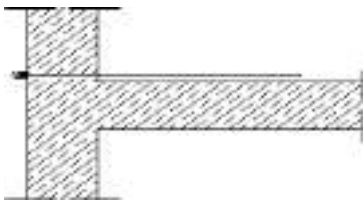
Planimetria e një tiranti të lidhur me murin e jashtëm në nivel ndërkati
